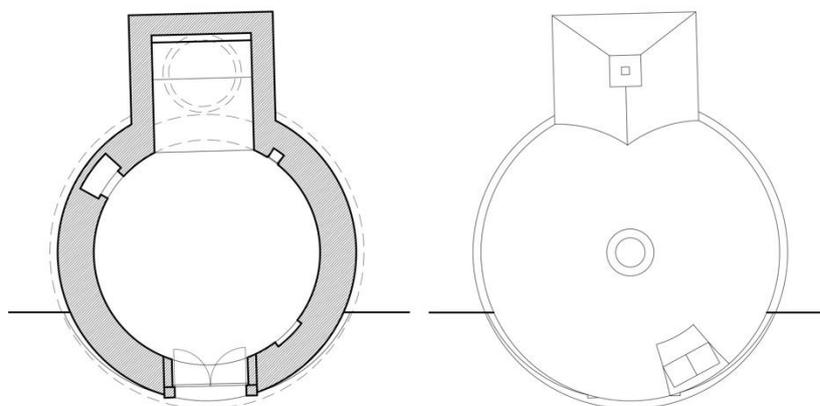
planta da capela, São Bartolomeu, Aveiro.
